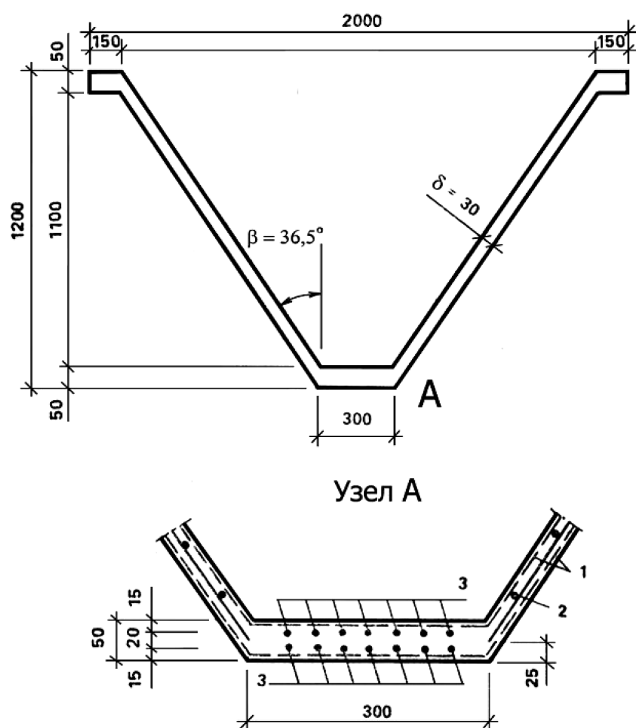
Сечение армоцементной складки покрытия пролетом 18 м с предварительно напряженной арматурой: 1 – тканая сетка № 10-1 по ГОСТ 3826; 2 – сварная сетка из проволоки Ø3 Вр-I; 3 – напрягаемая арматура Ø5 Вр1400
